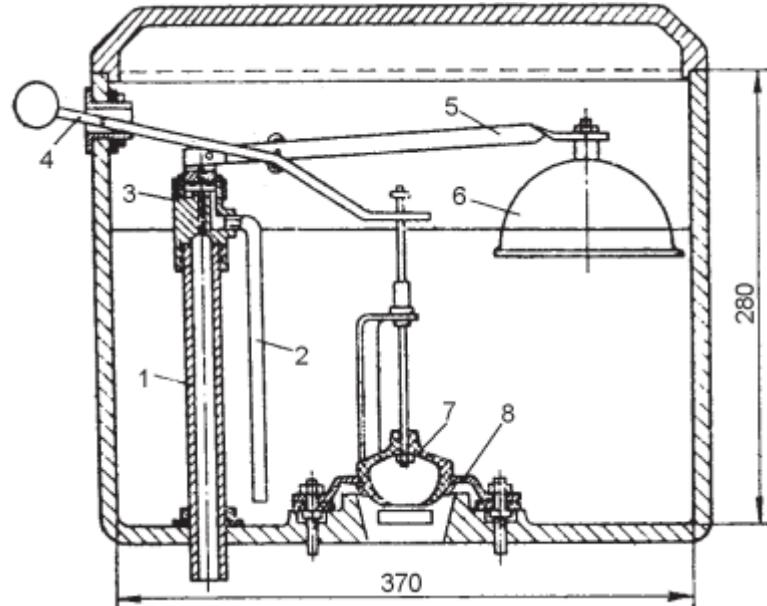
Низкорасположенный фаянсовый бачок: 1 – трубка; 2 – наливная трубка; 3 – поплавковый клапан; 4 – рычаг; 5 – рычаг поплавка; 6 – поплавок; 7 – резиновая «груша»; 8 – седло
